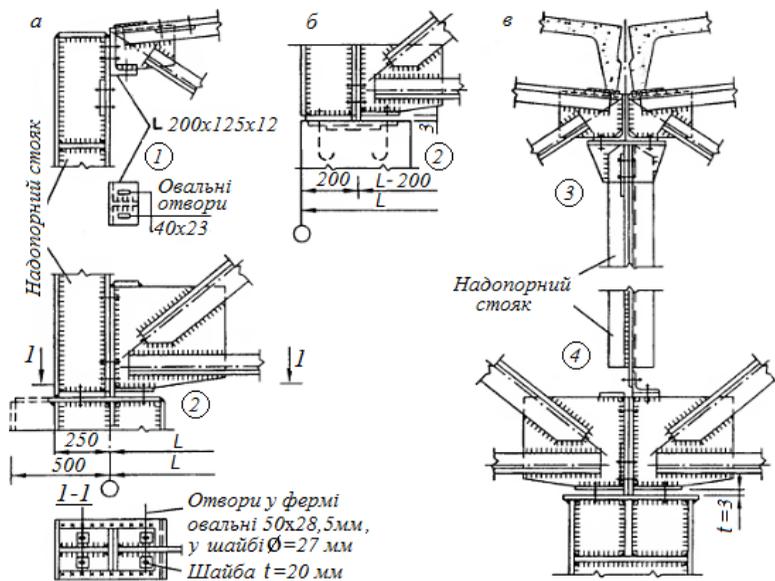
Опорні вузли сталевих ферм, шарнірно опертих на колоною: *а* - крайню сталеву; *б* - те ж залізобетонну; *в* - середню
